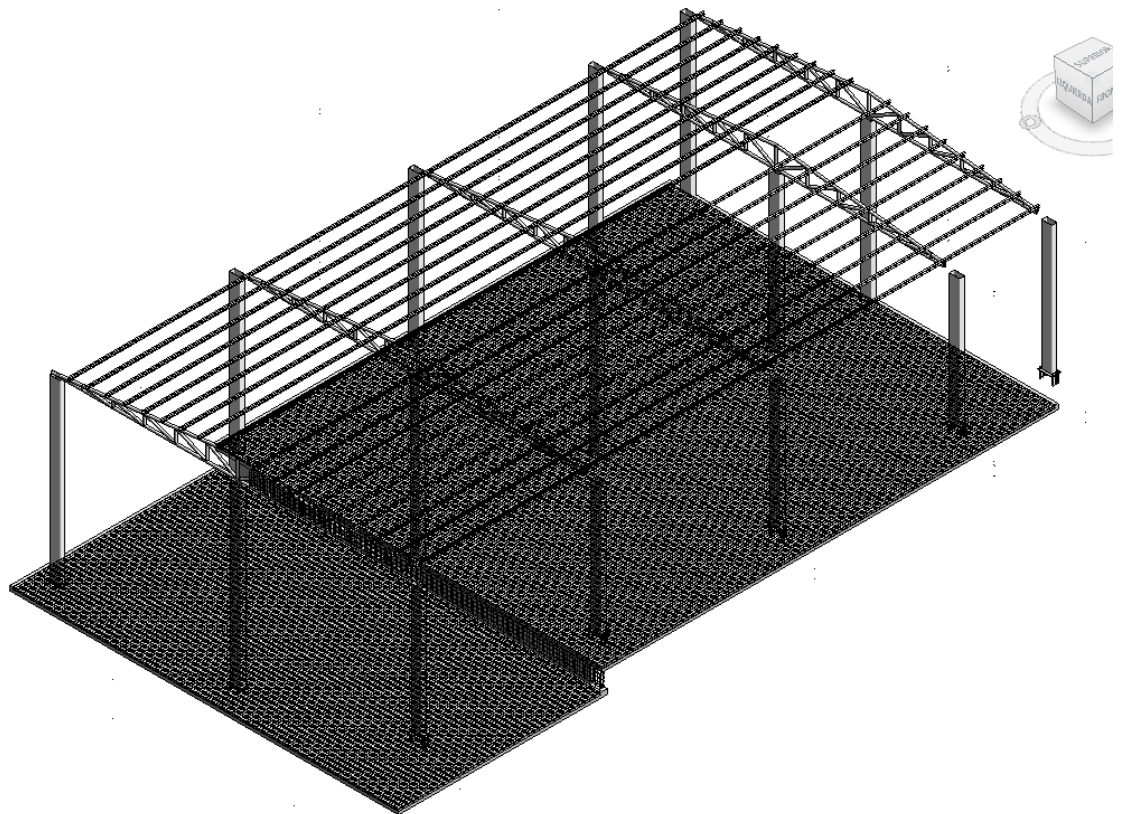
Isometría, planimetría de modelación estructural área de Cloro Gas
